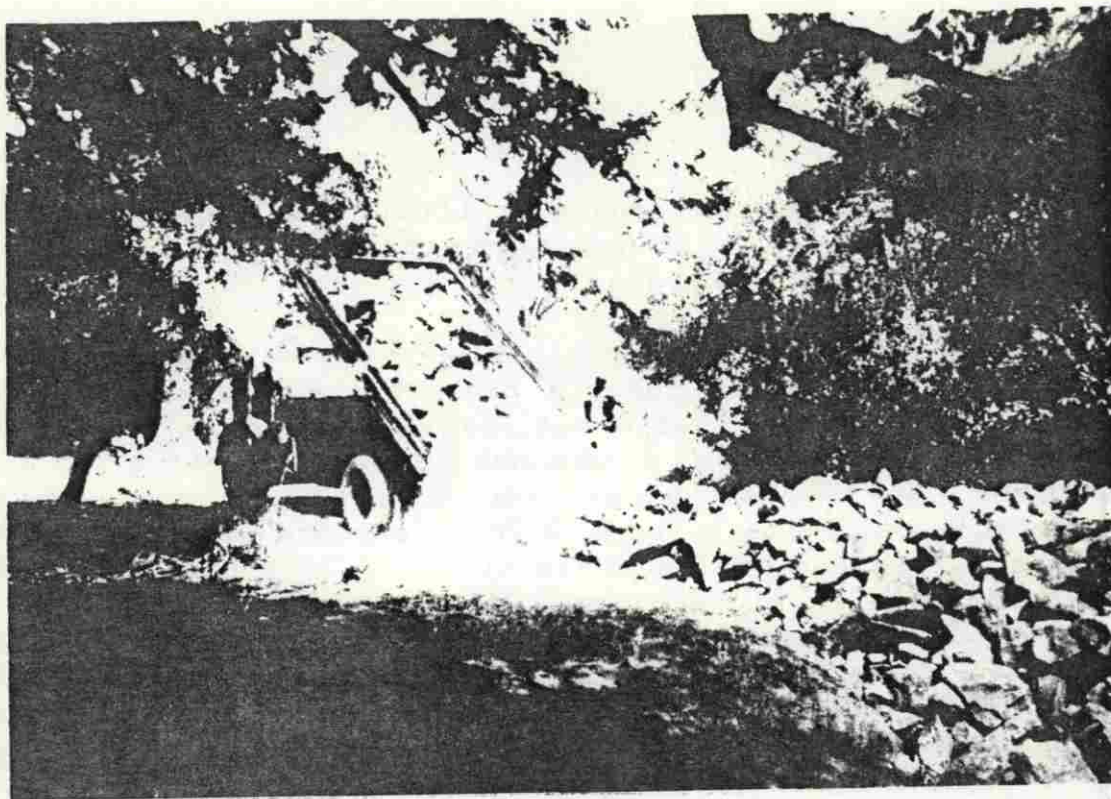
Digue filtrante en construction dans le village de Rissiam,
